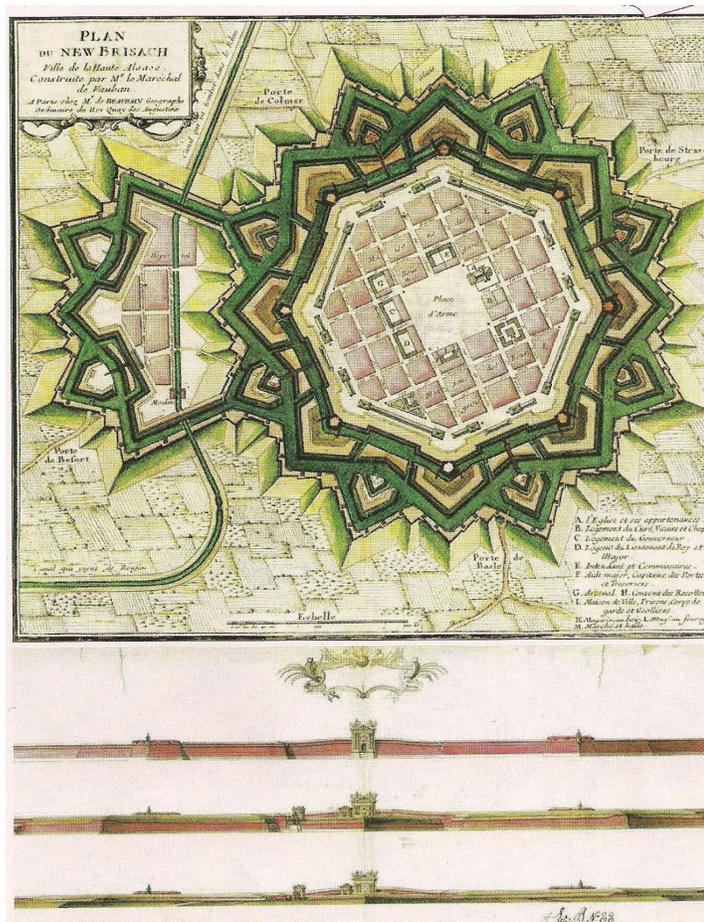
Plan de new Brisach – Vauban, 1698. Fonte: Revista “L’actualité de Histoire”: Vauban – L’homme aux 300 fortifications. Janvier 2007, n° 30, p. 35.
